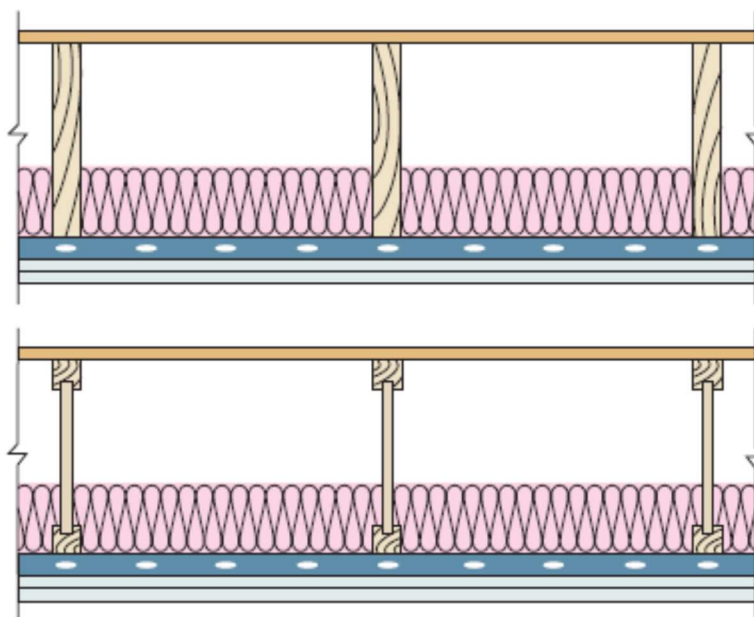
Pavimento de Madeira (PM3) (AA.VV., 2002).
